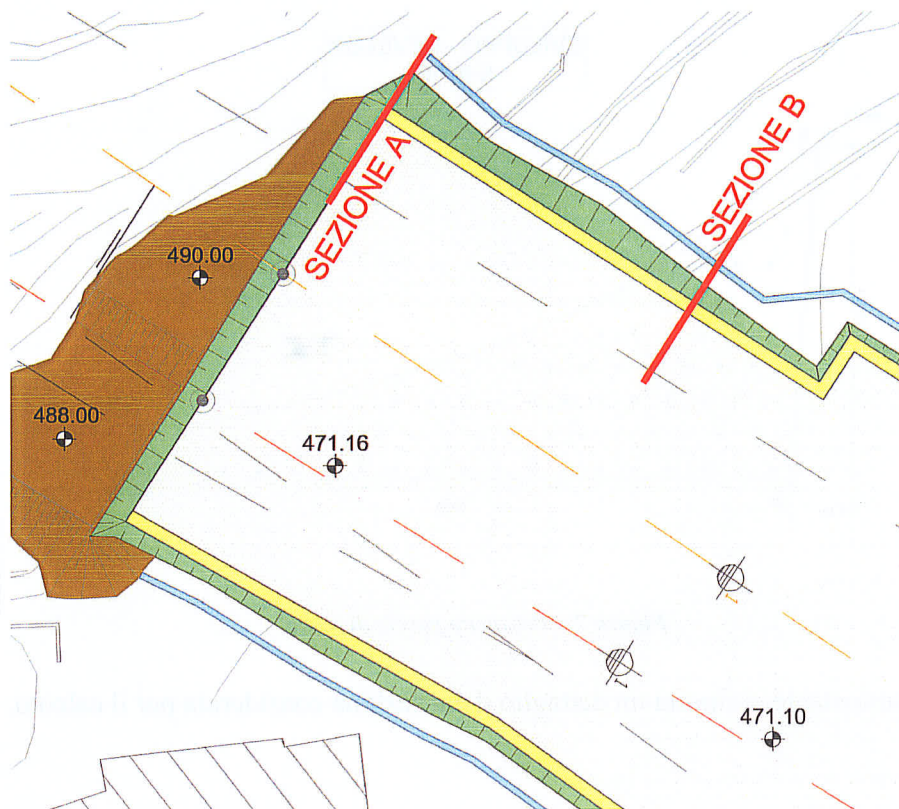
Dettaglio planimetria di imbocco con ubicate le sezioni di calcolo.
